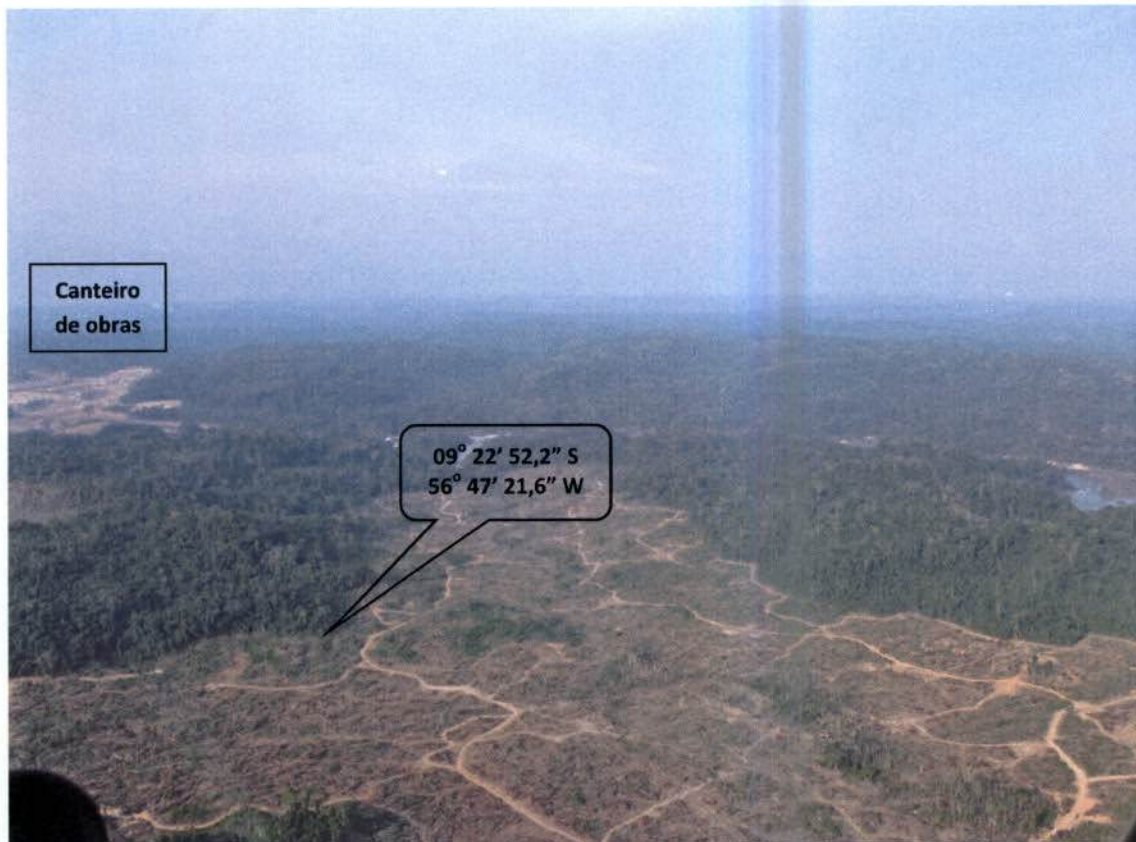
Área 03, Foto em 23/09/2014, Lote G localizado na margem esquerda do rio Teles Pires.
